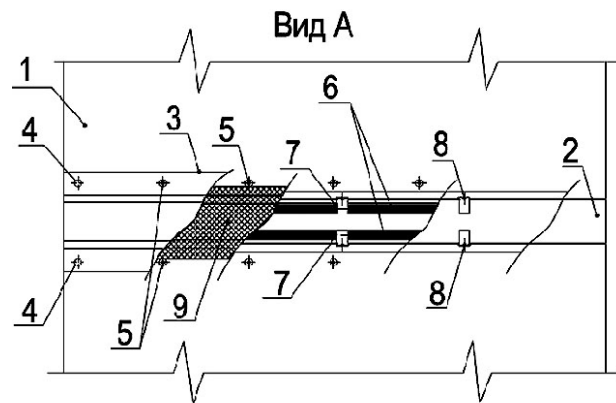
Фронтальный вид крепления устройства к конструкции стены.
